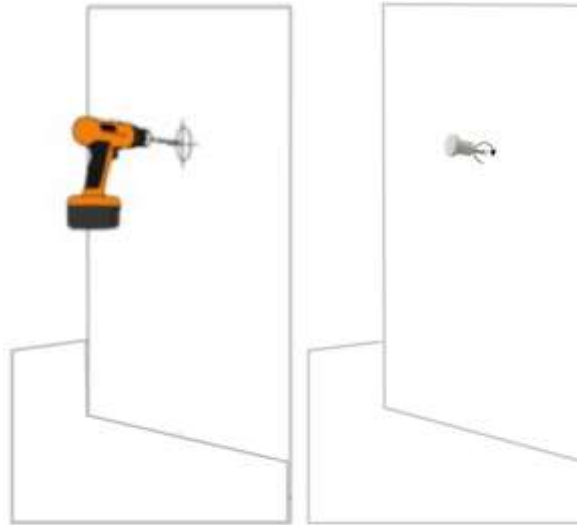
Proceso n° 1 guía de instalación. Fuente propia
